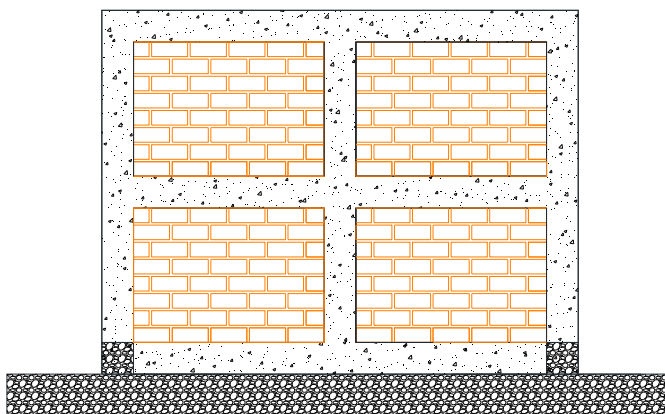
Mampostería de muros confinados. fuente (Elaboración propia)
